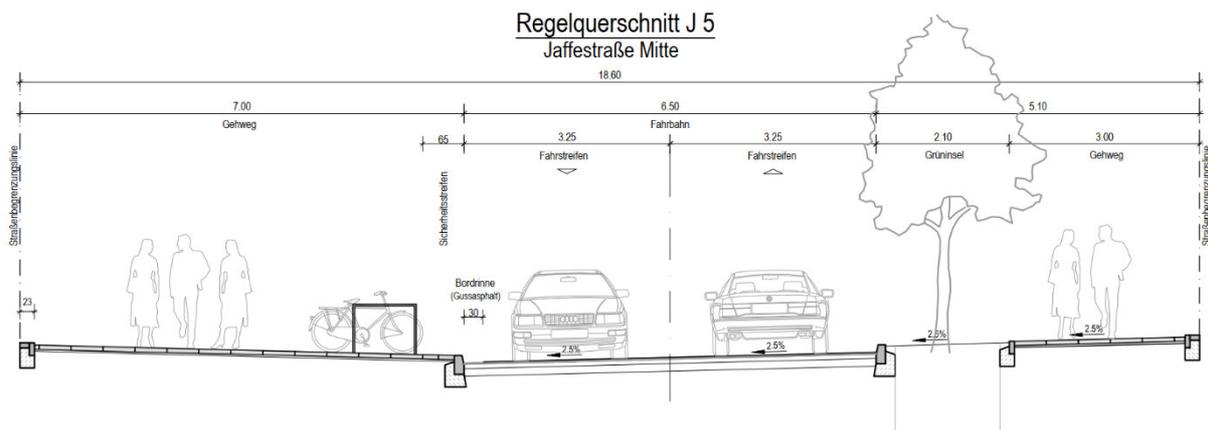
Querschnitt Jaffestraße zwischen Einmündung Planstraße A und Baufeld 6/8
